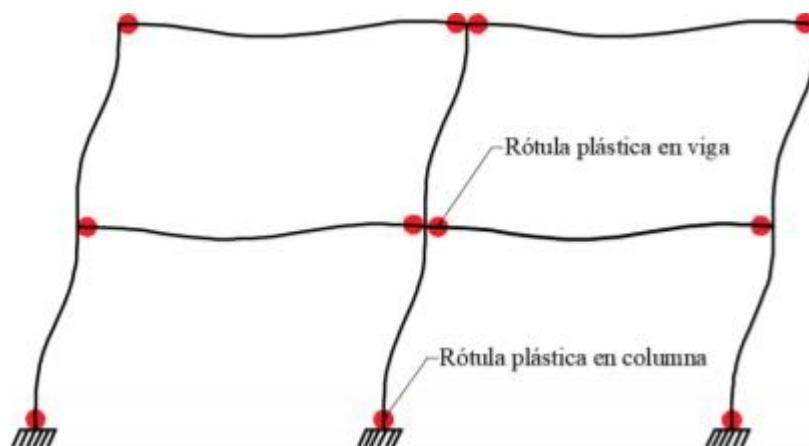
Visualización de Rótulas Plásticas en Pórtico
